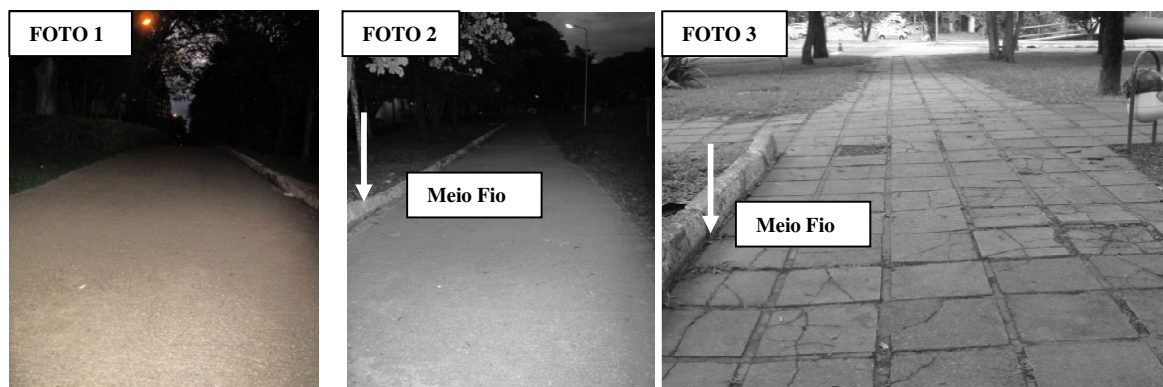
Foto 1, vista Oeste da calçada A e do meio fio; Foto 2, vista Leste; Foto 3, o trecho em mau estado
